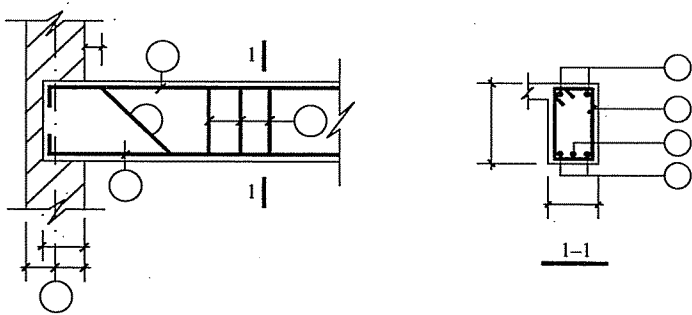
梁纵、横断面图中钢筋表示方法
